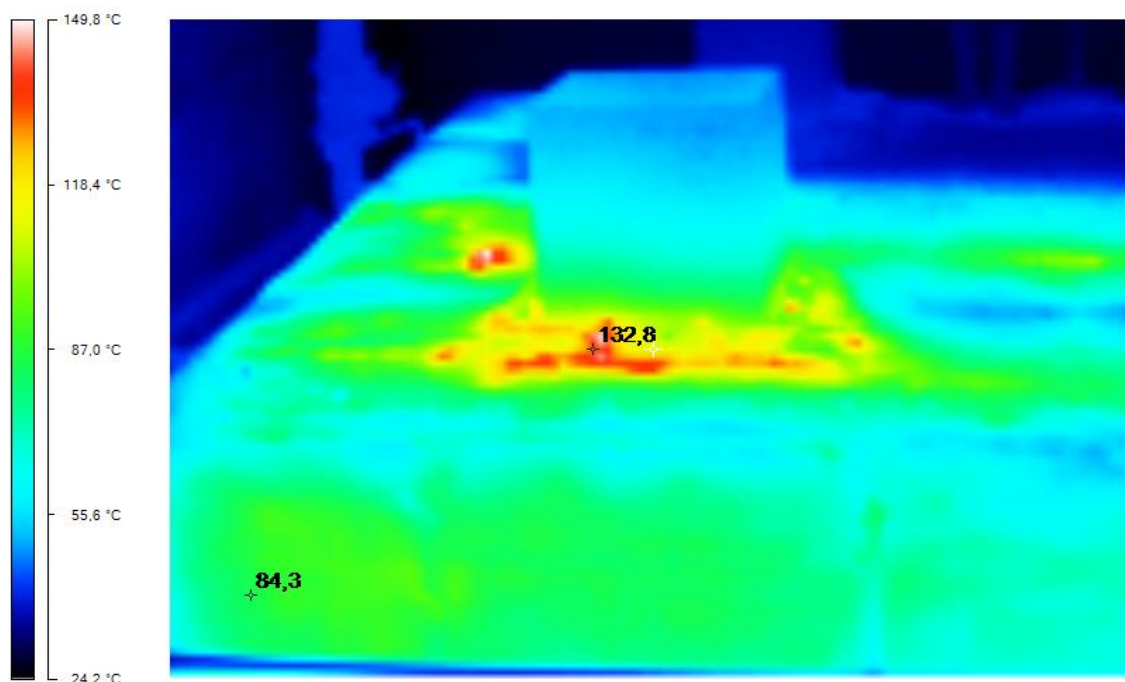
Стан мурування поверхні робочого котла №2
